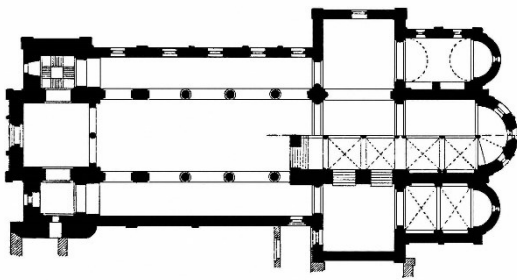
Grundriss der Klosterkirche Jerichow
